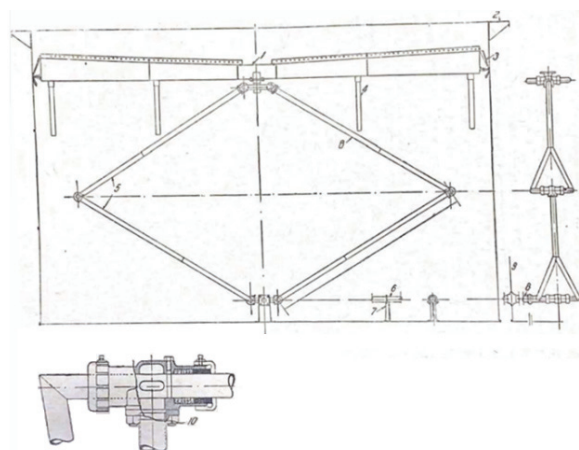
Общий вид резервуара с плавающей крышей Галлахера
